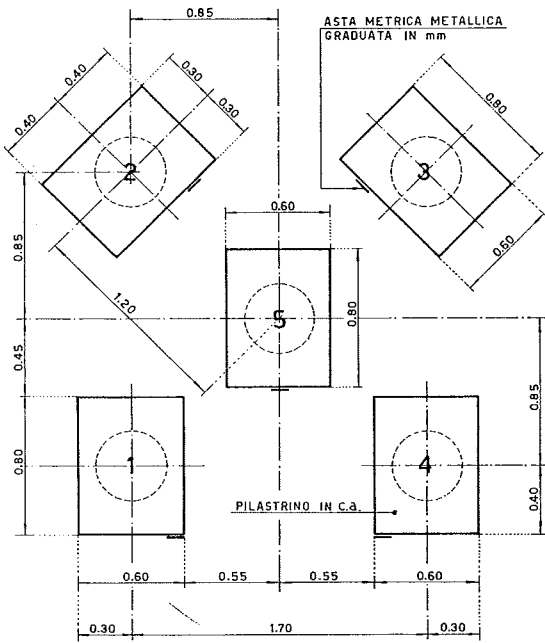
Gruppi di 5 pali. Ubicazione planimetrica.
